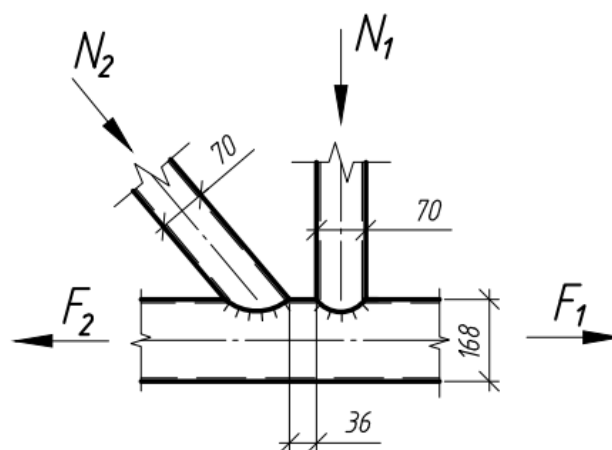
Для расчета безфасоночных узлов ферм из круглых труб
